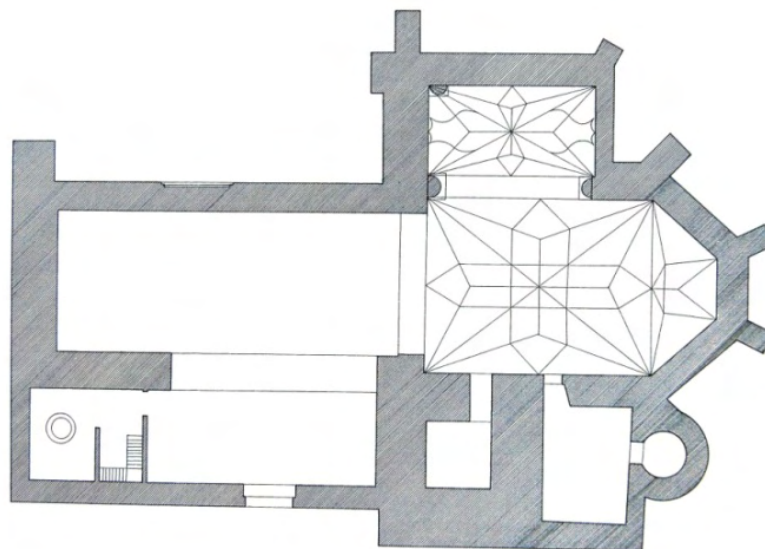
Planta de M. T. Sánchez Trujillano⁸⁵. 2002.
